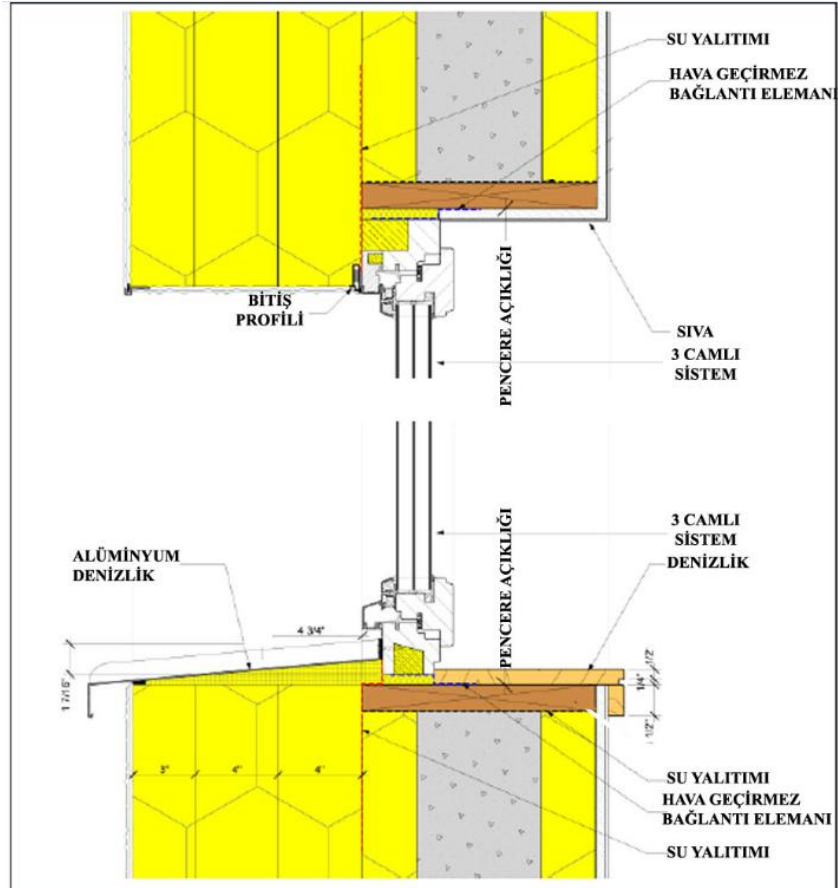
Bina kesiti (Passive House In The Woods, bt)
